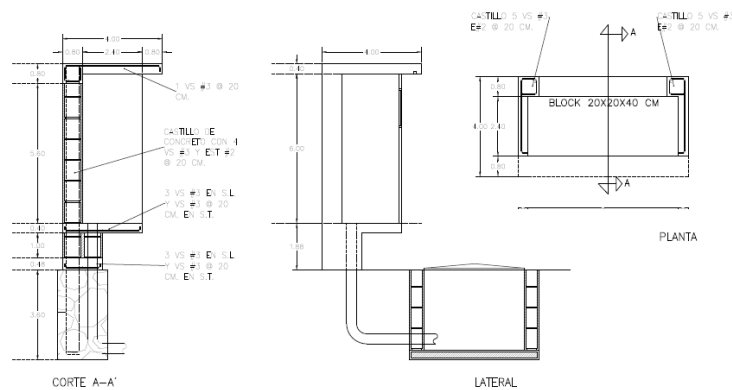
Detalle constructivo de murete para alojar el tablero general.
